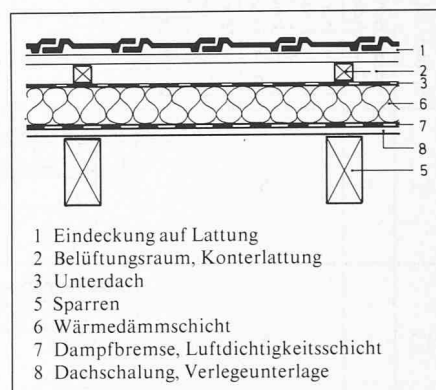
Neuere, konventionell über den Sparren wärmege­dämmte Steildachkonstruktion (Querschnitt)
